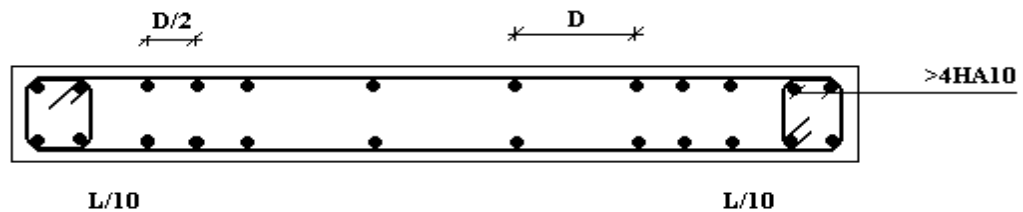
Disposition des Armatures verticales dans les voiles.
